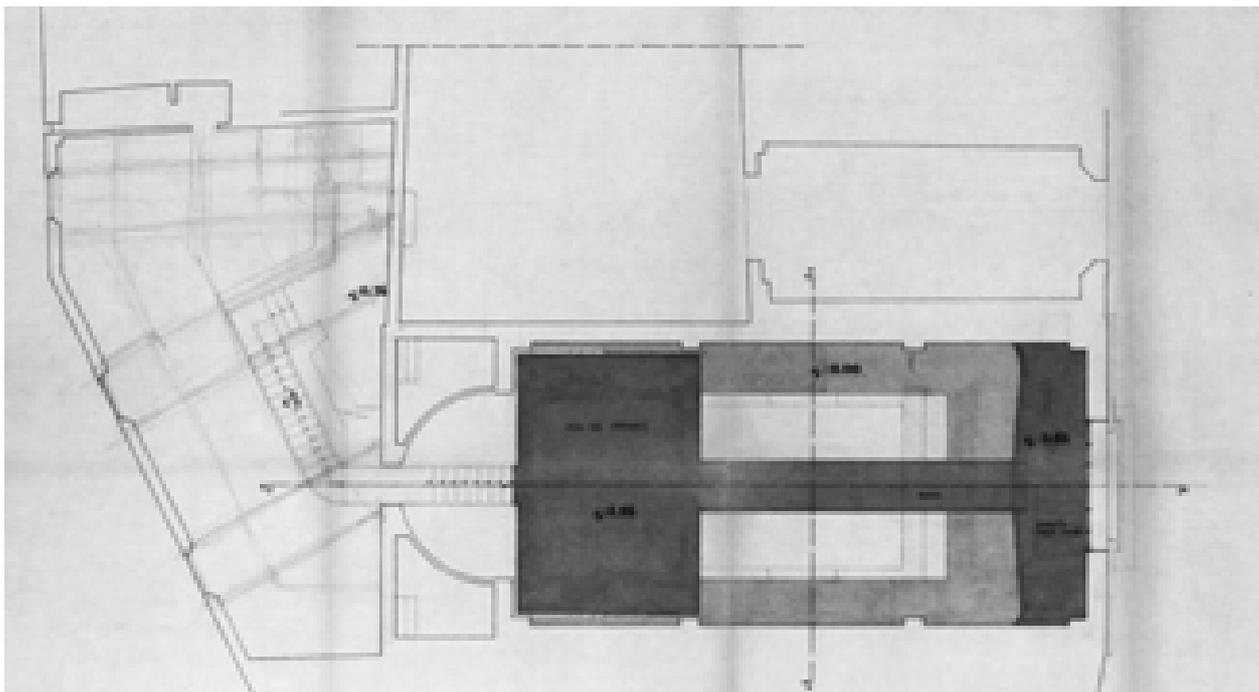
San Leonardo, pianta +4,95 – stato futuro - s.d. (AABS-94.070)
